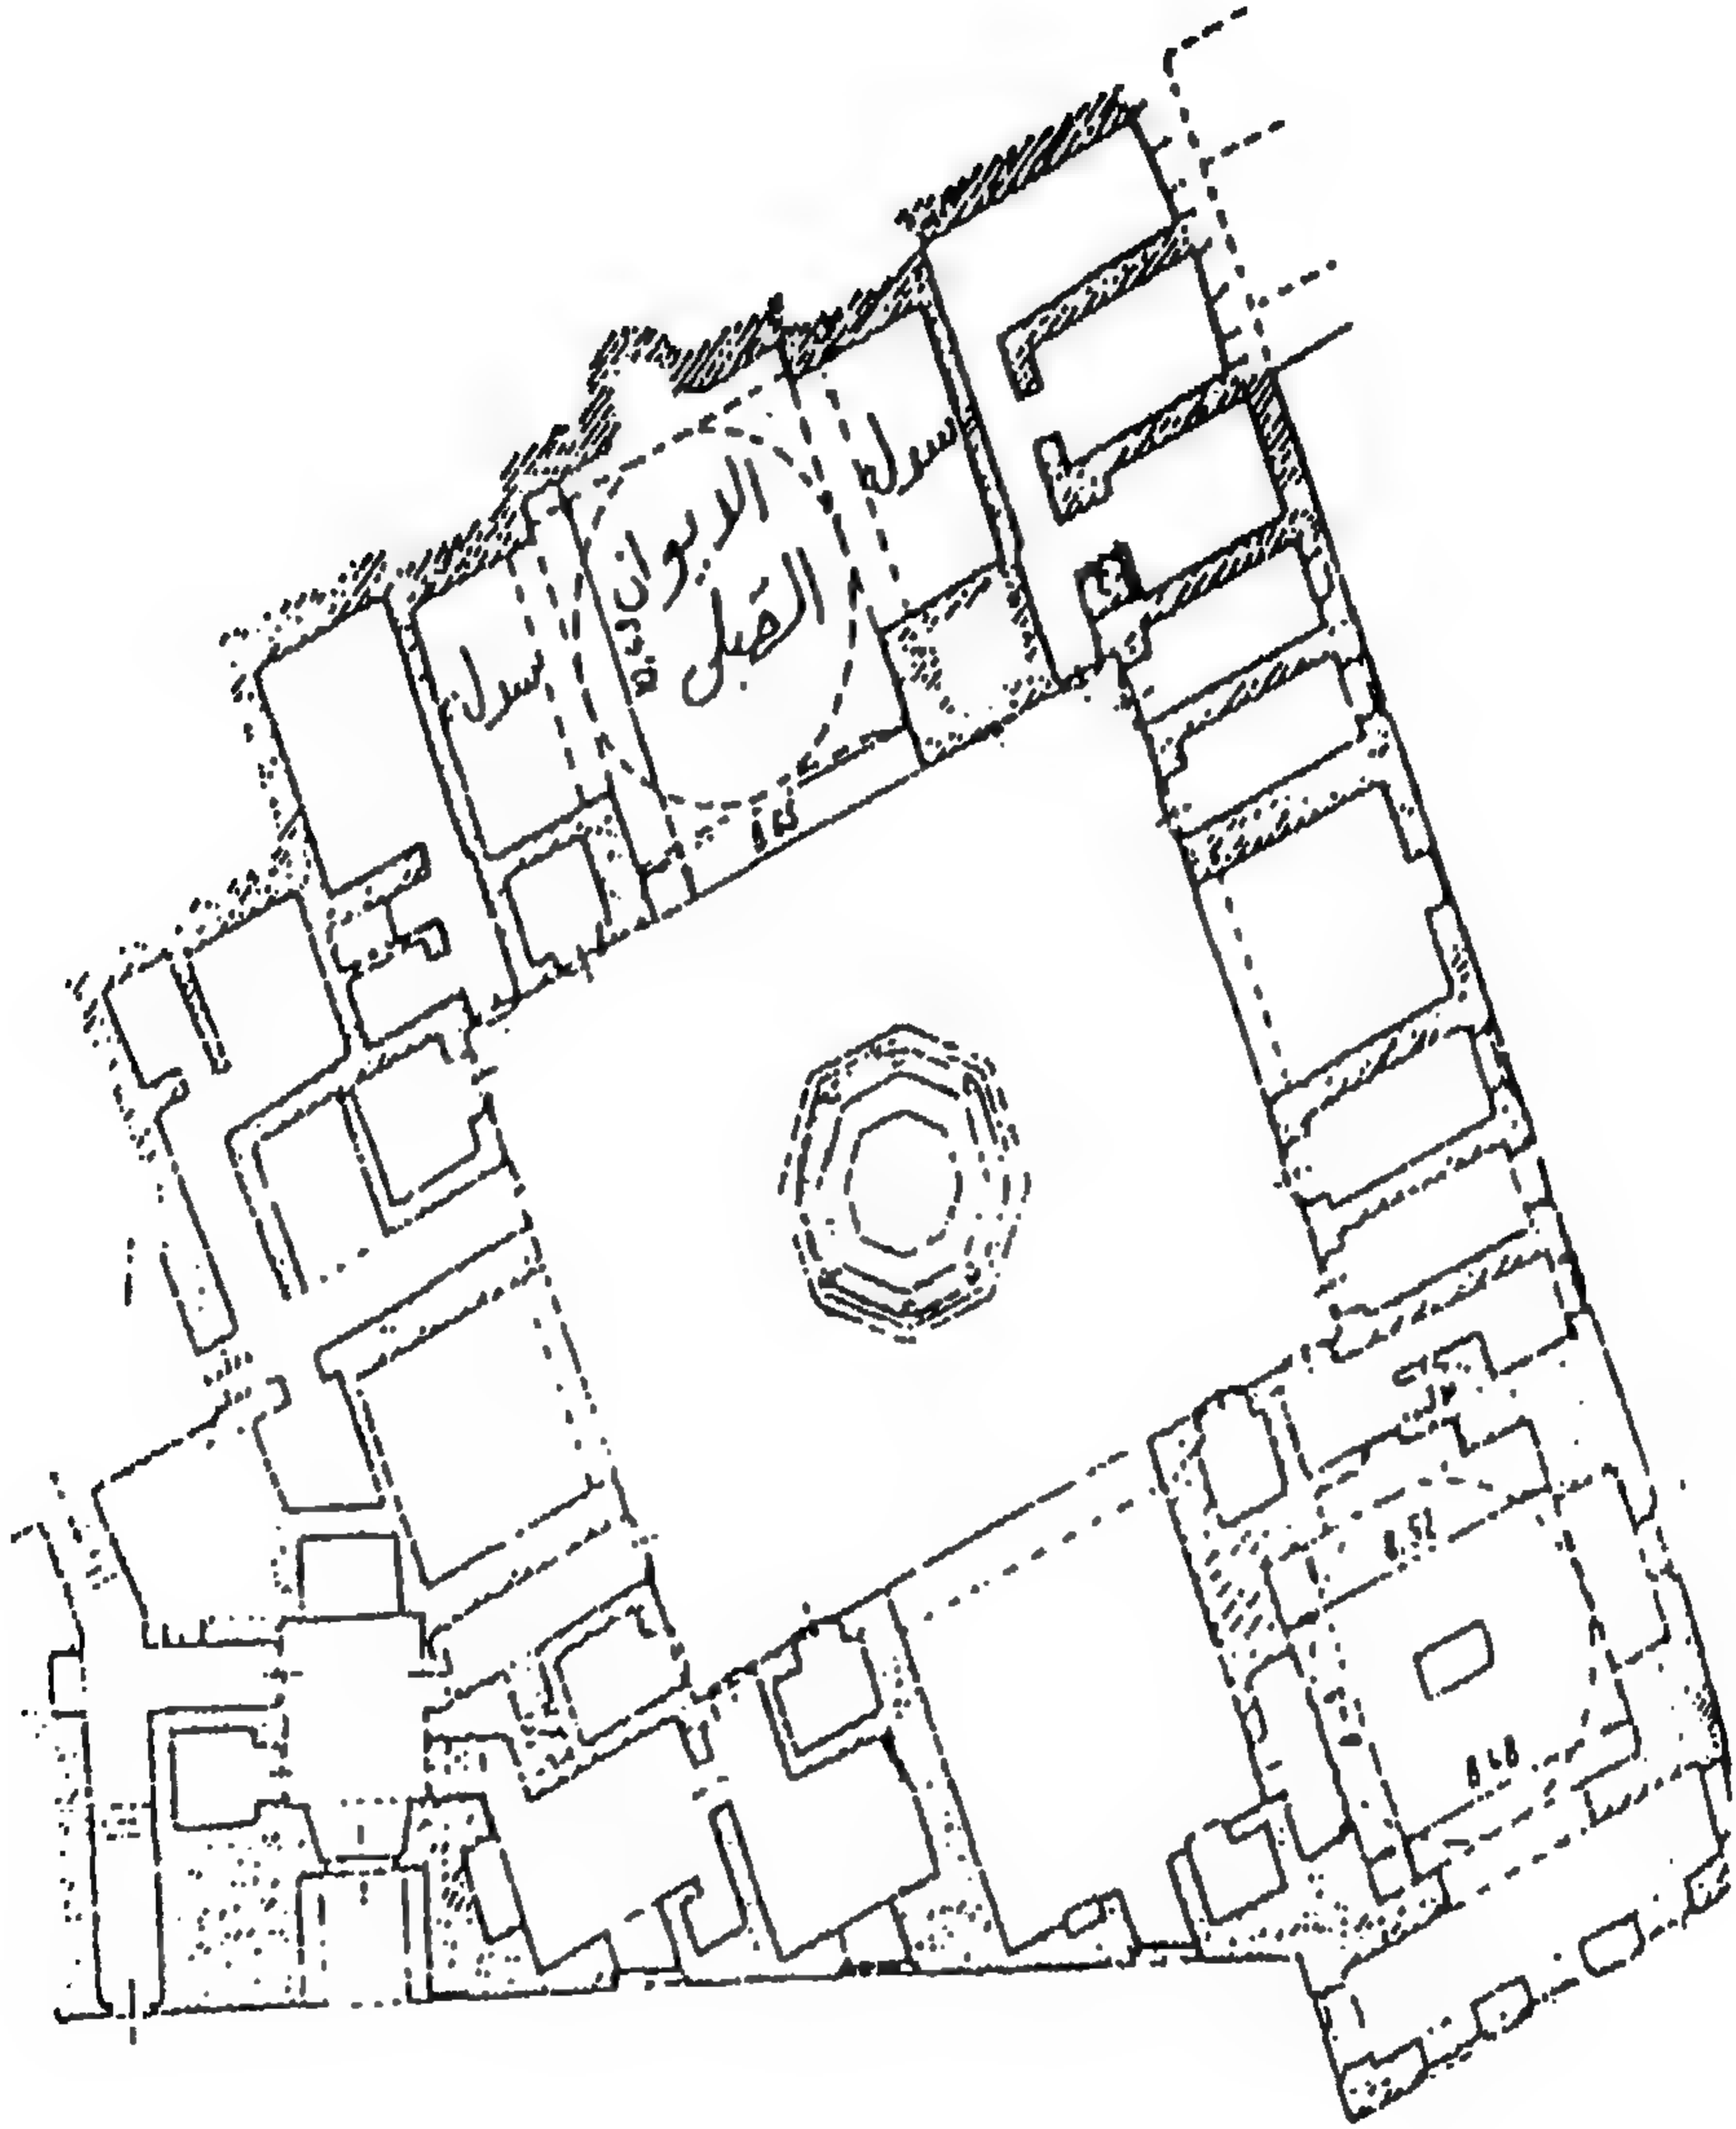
مسقط أفقي لجمع السلطان قلاوون بالقاهرة (عن : Greswell)
